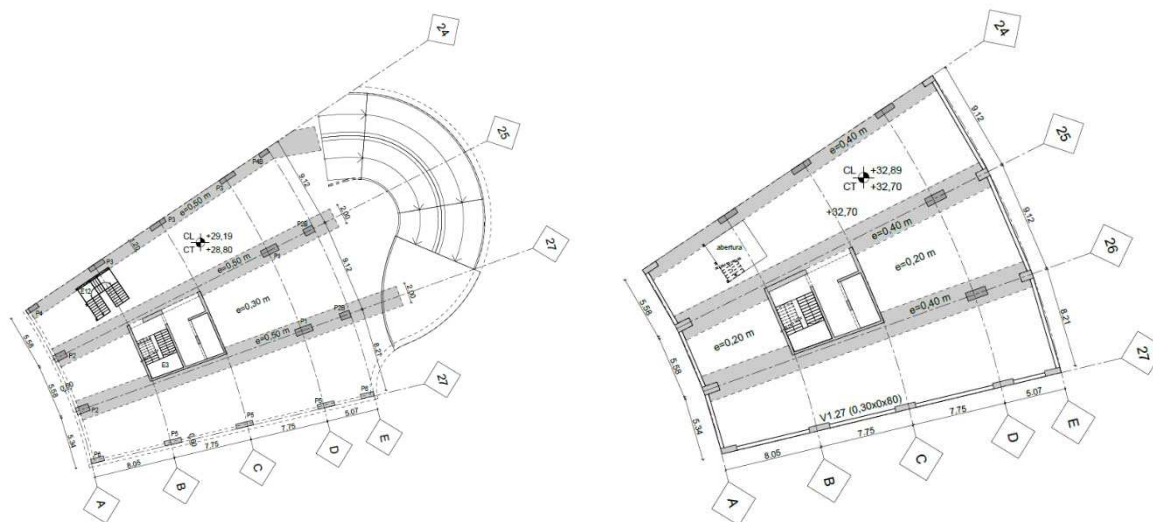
Plantas estruturais existentes do edifício da Torre Nascente
